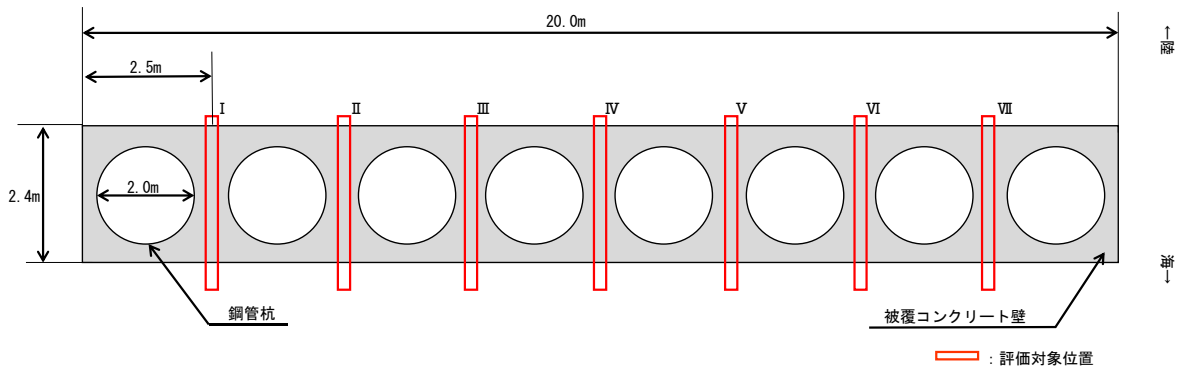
(1) 評価対象位置図 (③-③断面, 平面図)
